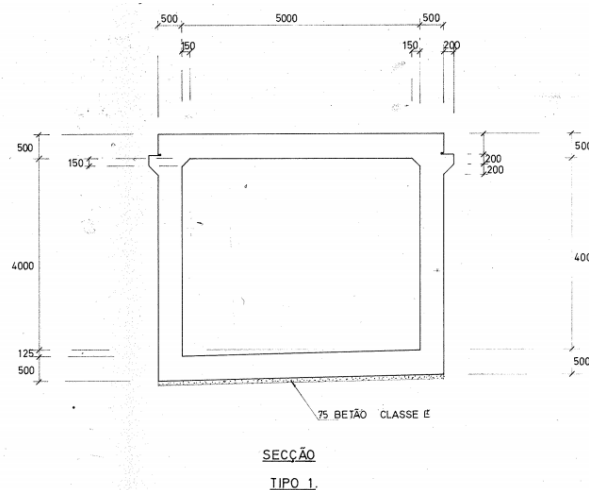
CORTE TRANSVERSAL DA PA EM SERVIÇO.
